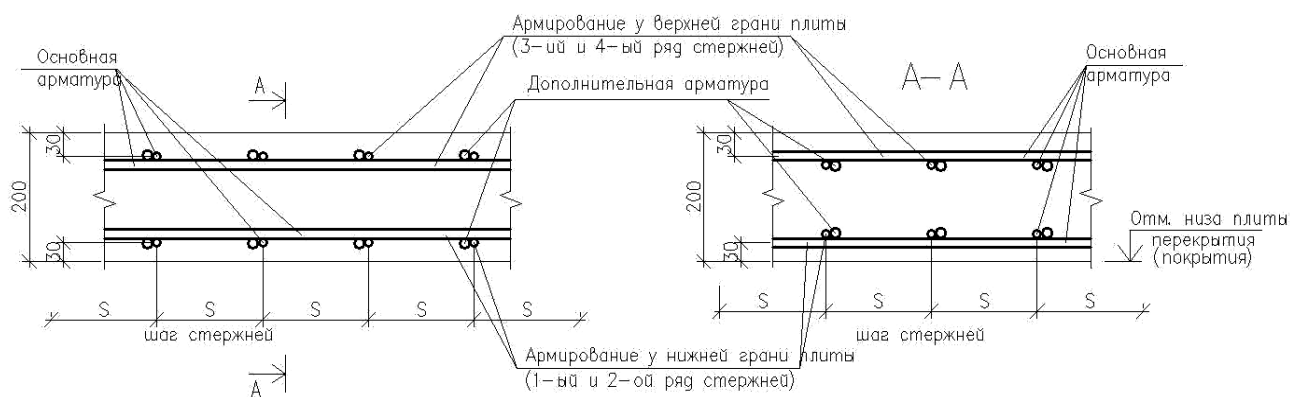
Фрагмент армирования плиты безбалочного межэтажного перекрытия
